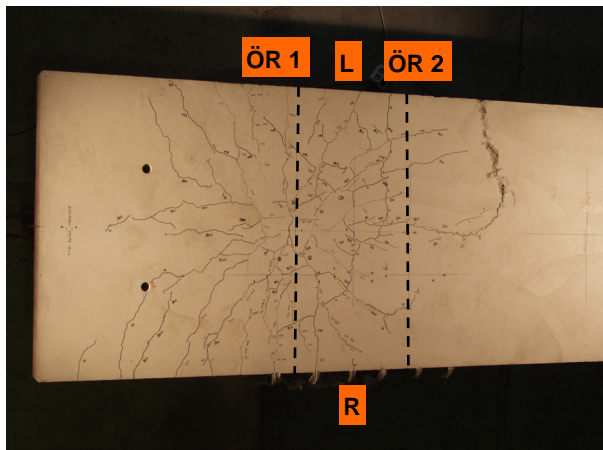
Rissbild auf der Betongurtoberseite
